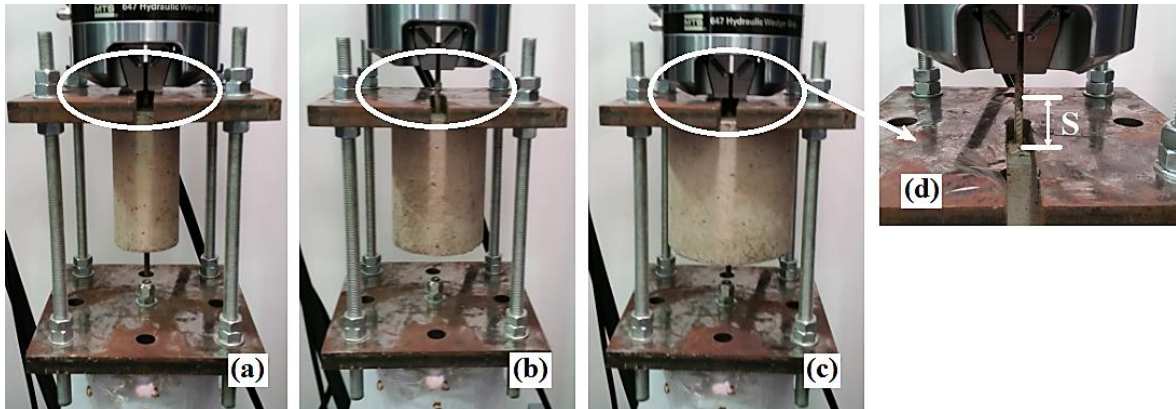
Ensaios da Etapa II: (a) Ensaio dos corpos de prova de 100 mm de diâmetro, (b) Ensaio dos corpos de prova de 150 mm de diâmetro, (c) Ensaio dos corpos de prova de 200 mm de diâmetro, (d) Deslizamento da barra durante o ensaio.
